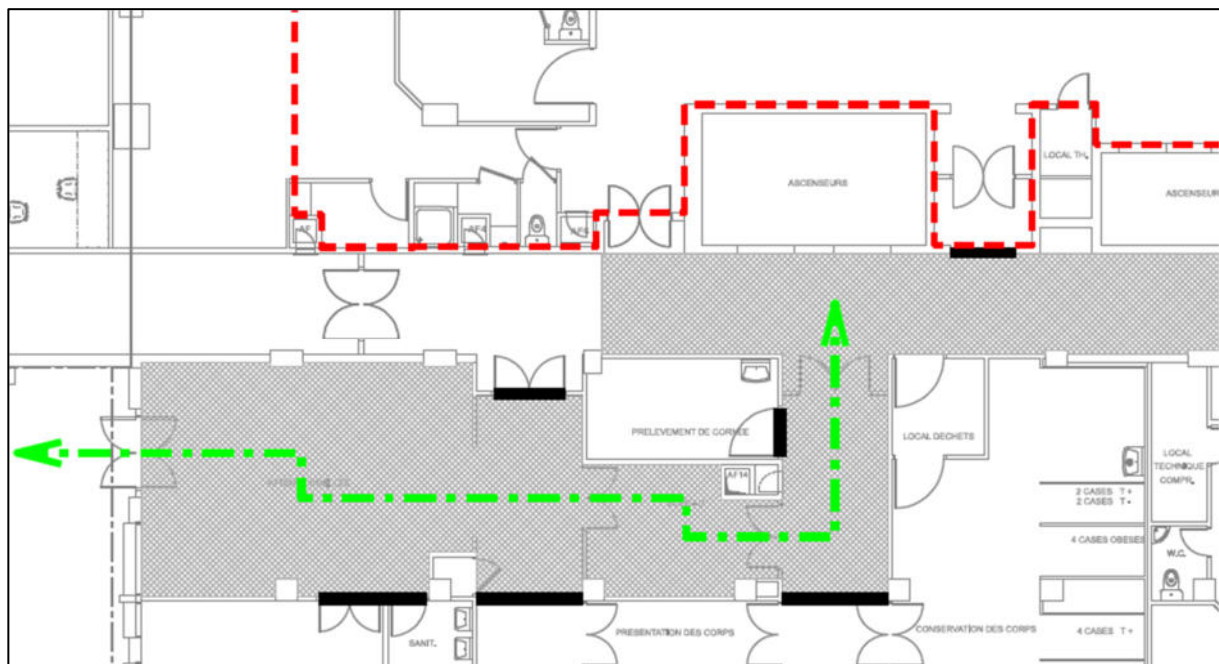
Extrait du Plan d'Installations de Chantier (PIC) – Annexe 1 – Zone de transit
